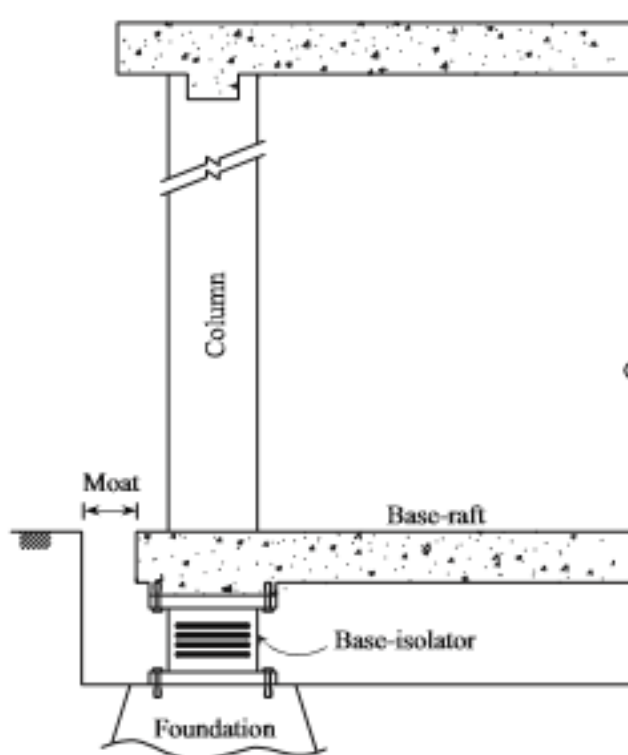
Isolamento de base em estruturas de betão armado (Matsagar & Jangid, 2008)
